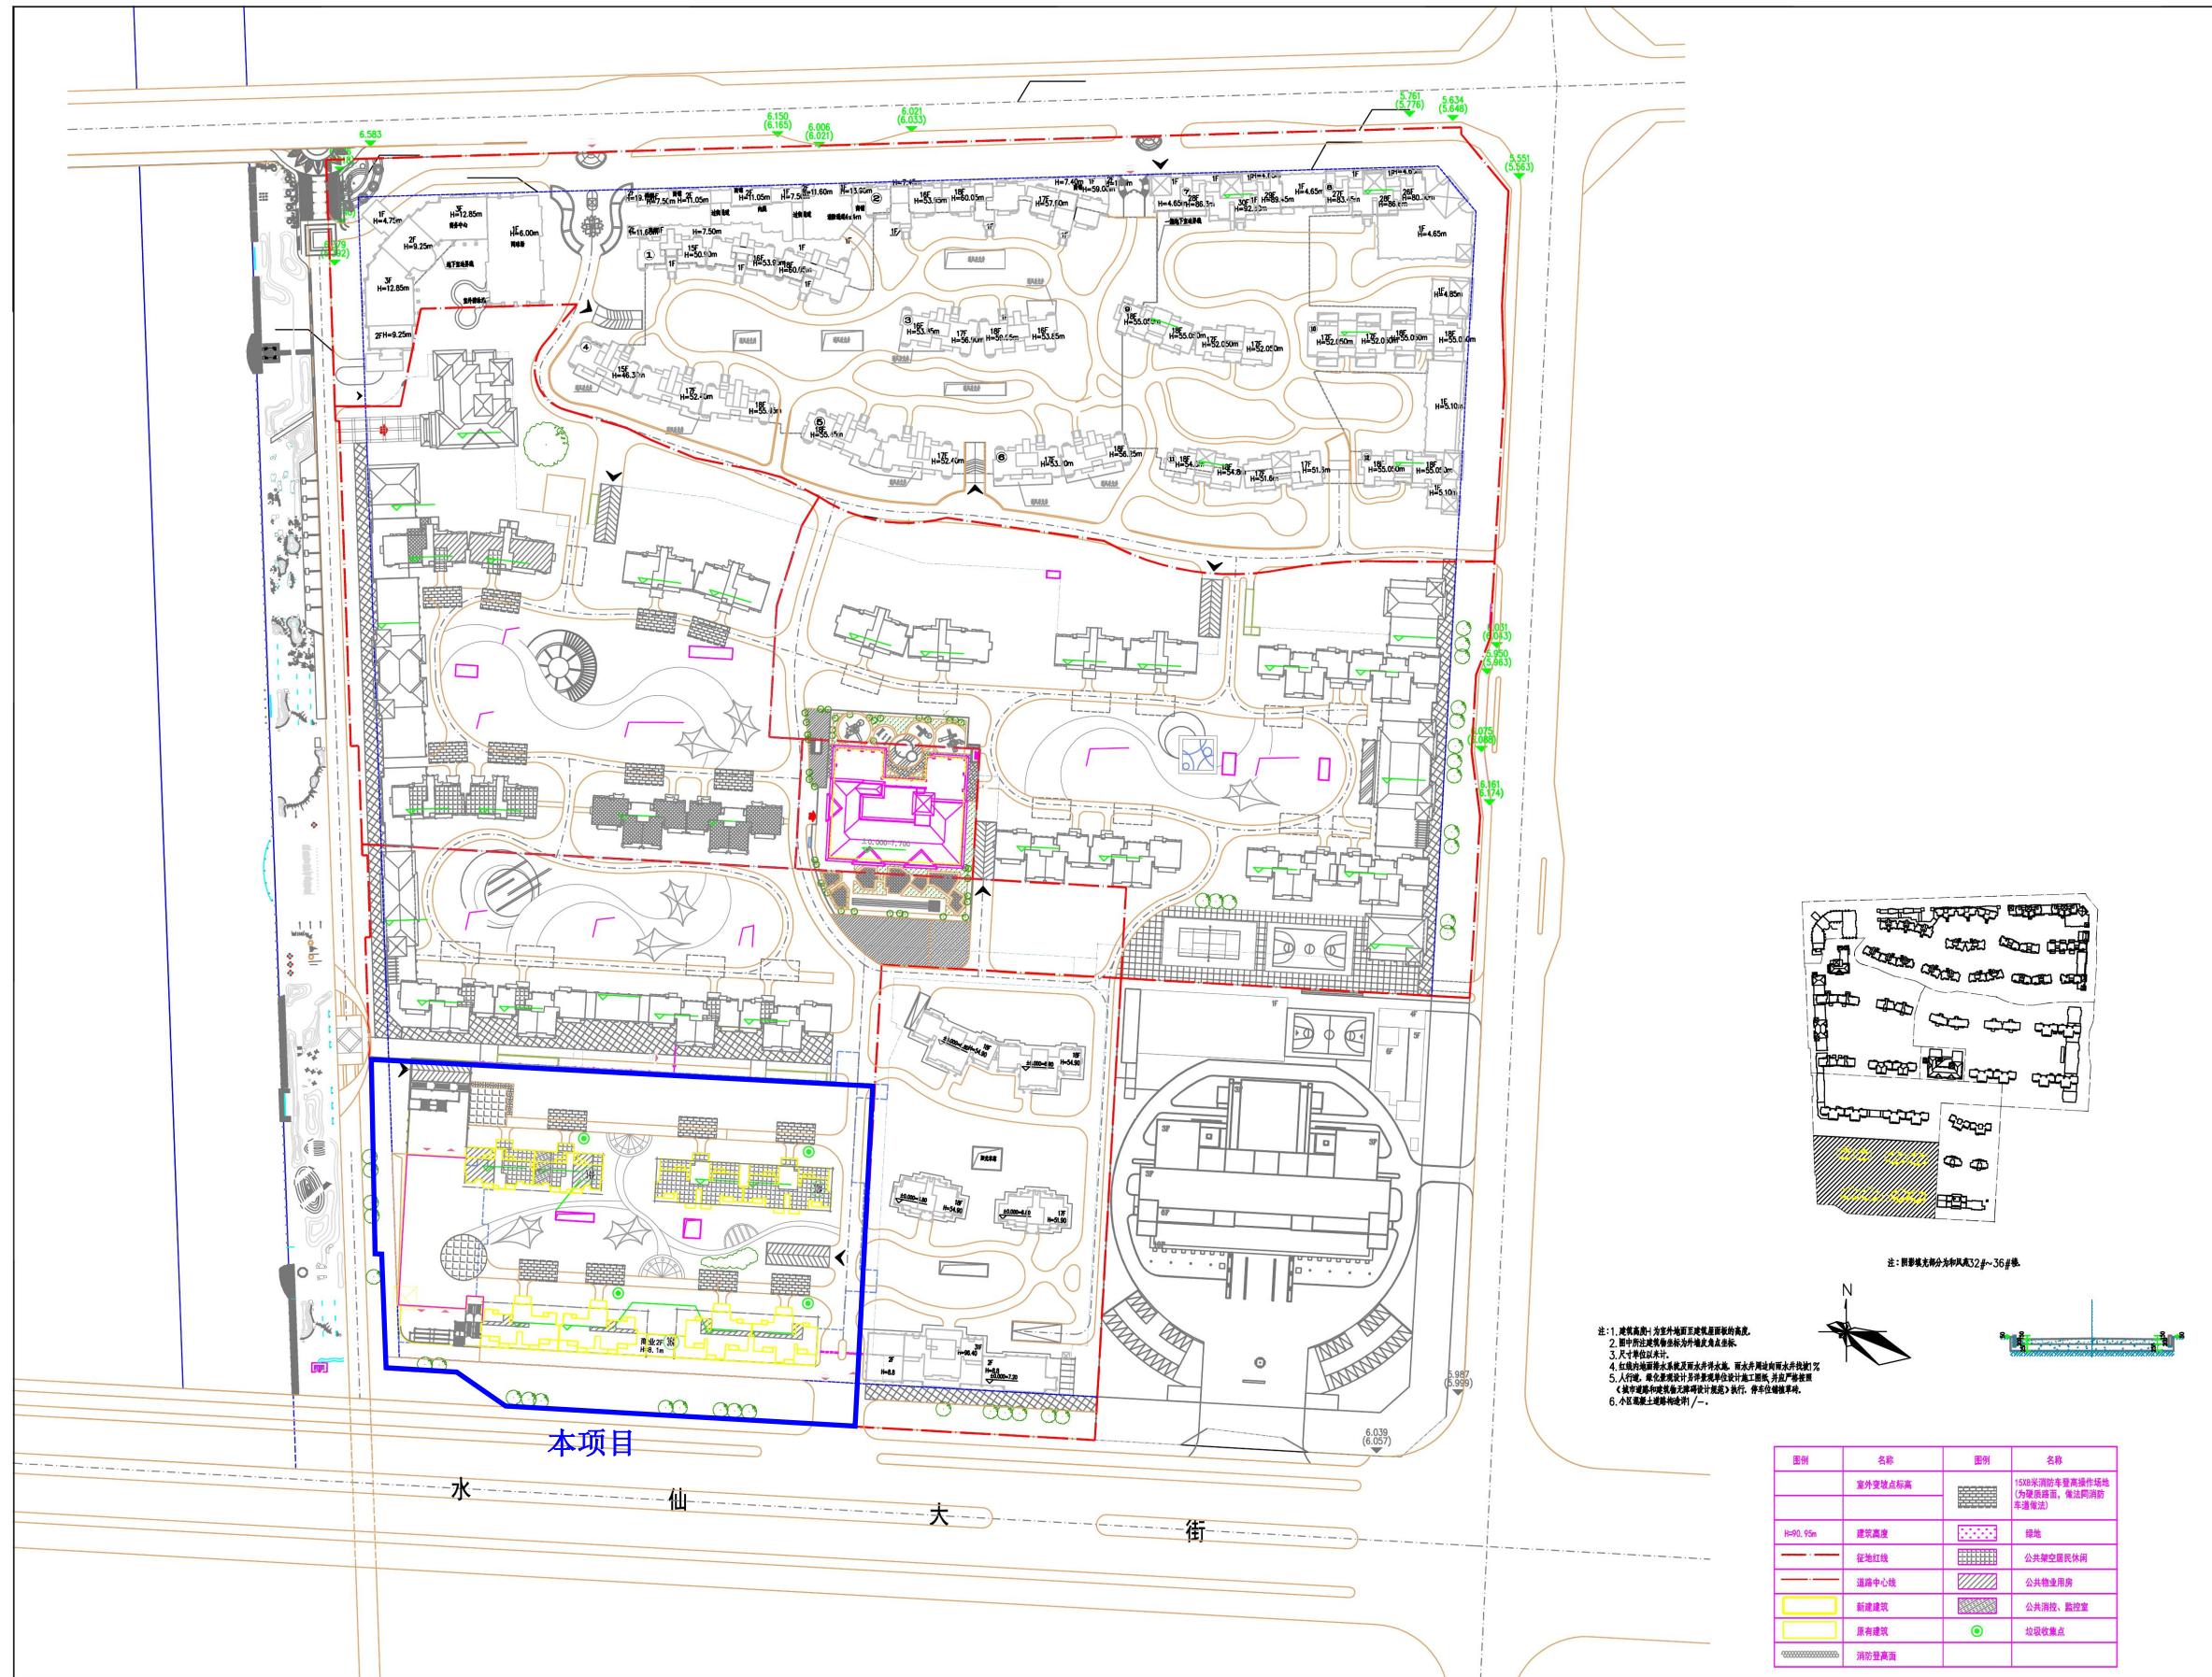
项目总平面布置图 (蓝色粗线框内为本项目)
